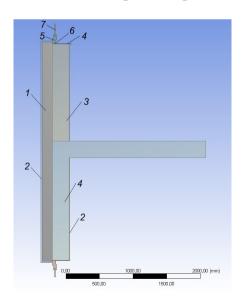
Геометрическая модель ограждающей конструкции здания: 1- минераловатная плита; 2- штукатурка; 3- кирпичная кладка; 4- железобетон; 5- железобетонная рама; 6- пена монтажная; 7- стеклопакет
